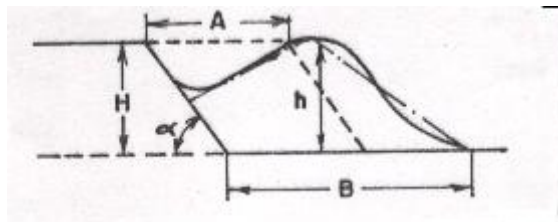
Esquema para el cálculo del ancho del bloque (franja).
